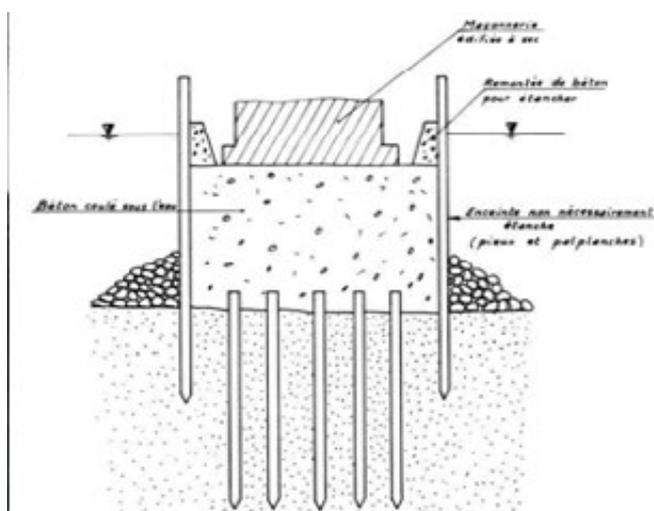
Fondation sur pieux enchâssés dans un massif de béton de chaux (crédit J-P Levillain)
